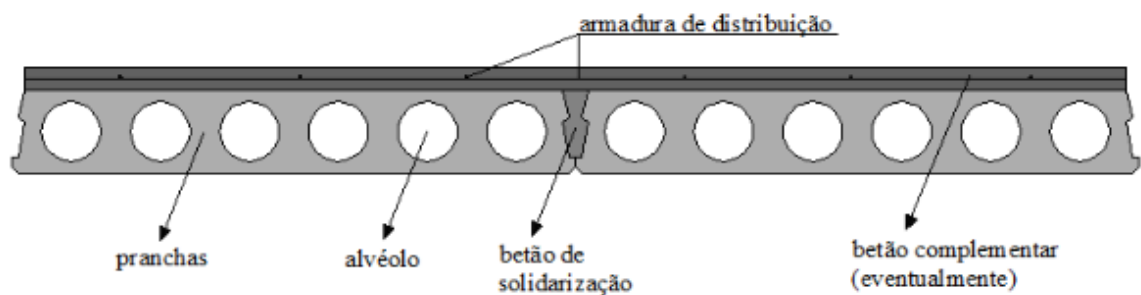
Pormenor de ligação de 2 lajes alveolares [5]
